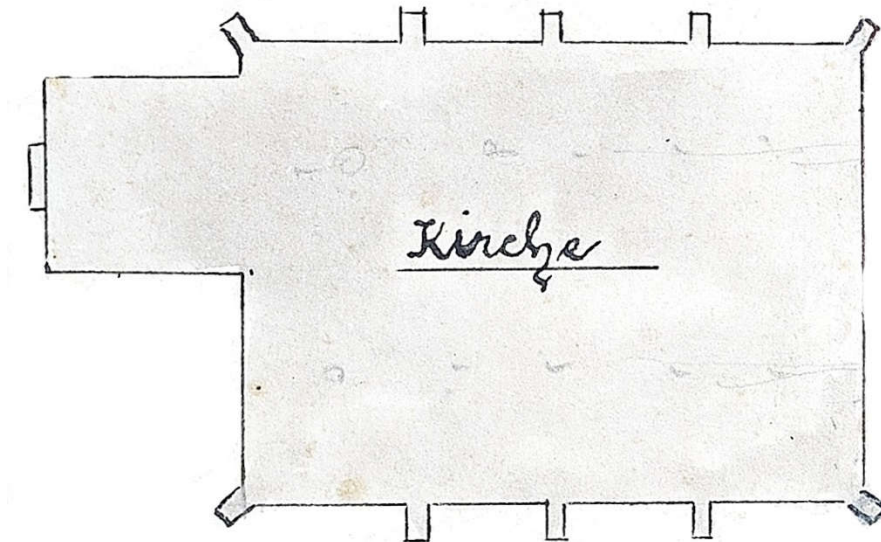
Grundriss der Kirche im Jahre 1904 vor dem Umbau
